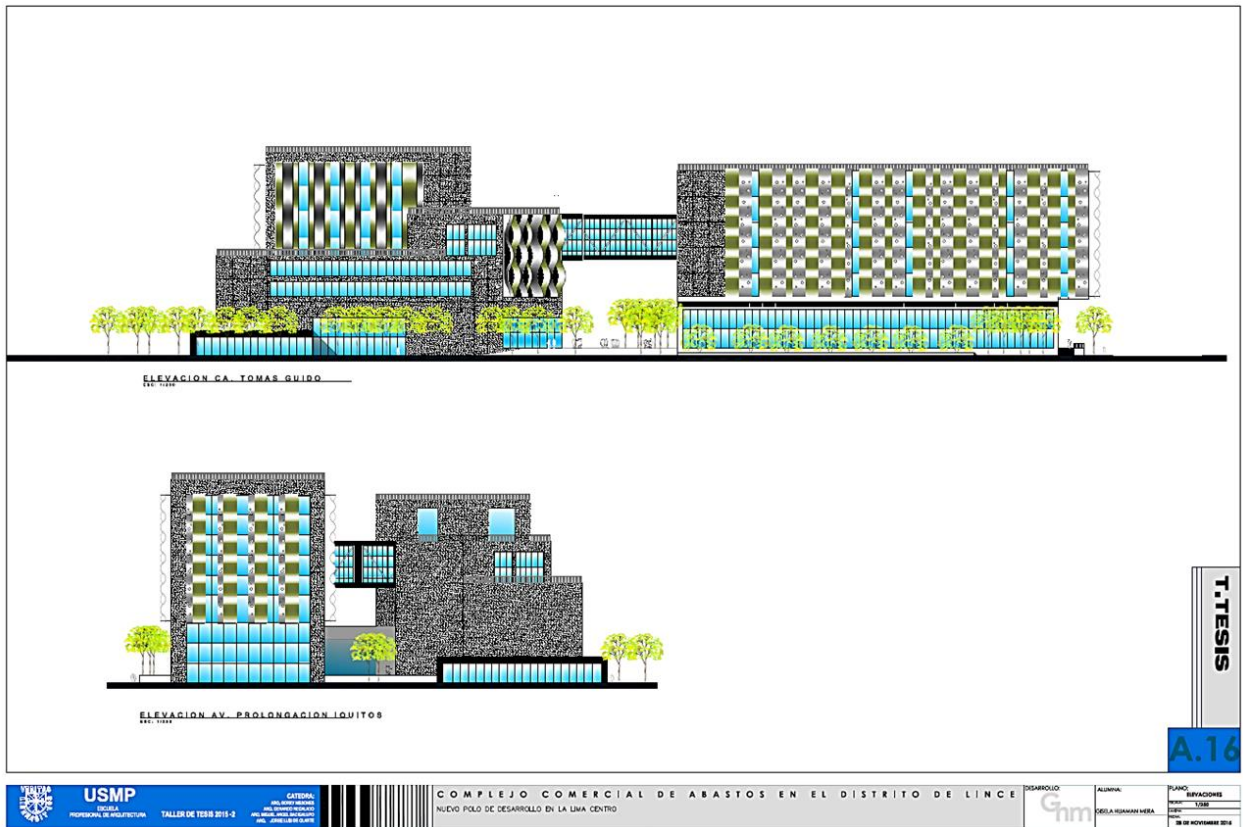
Plano Elevación Norte y Elevación Este. Elaboración: la autora.
